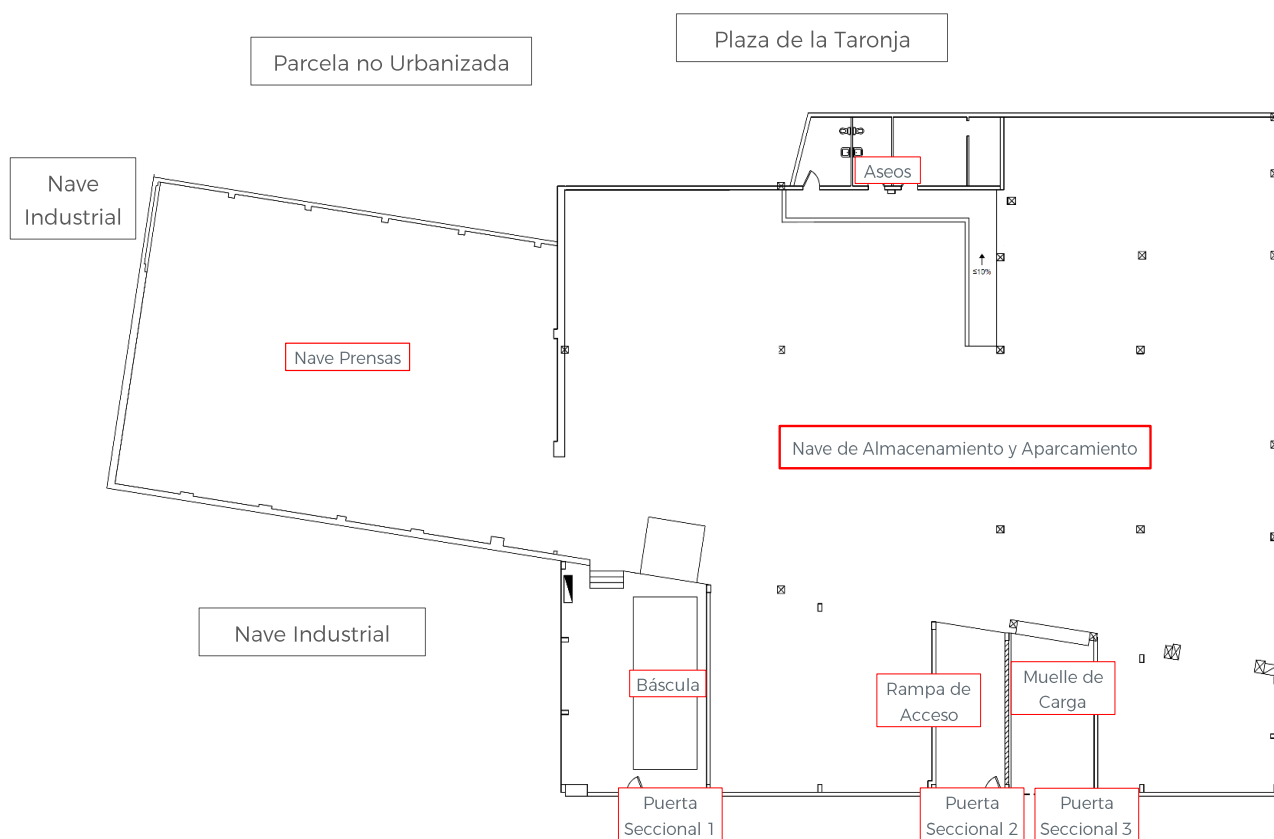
Planta Baja Nave – Plaza de la Taronja 1 y 3, Picanya.
